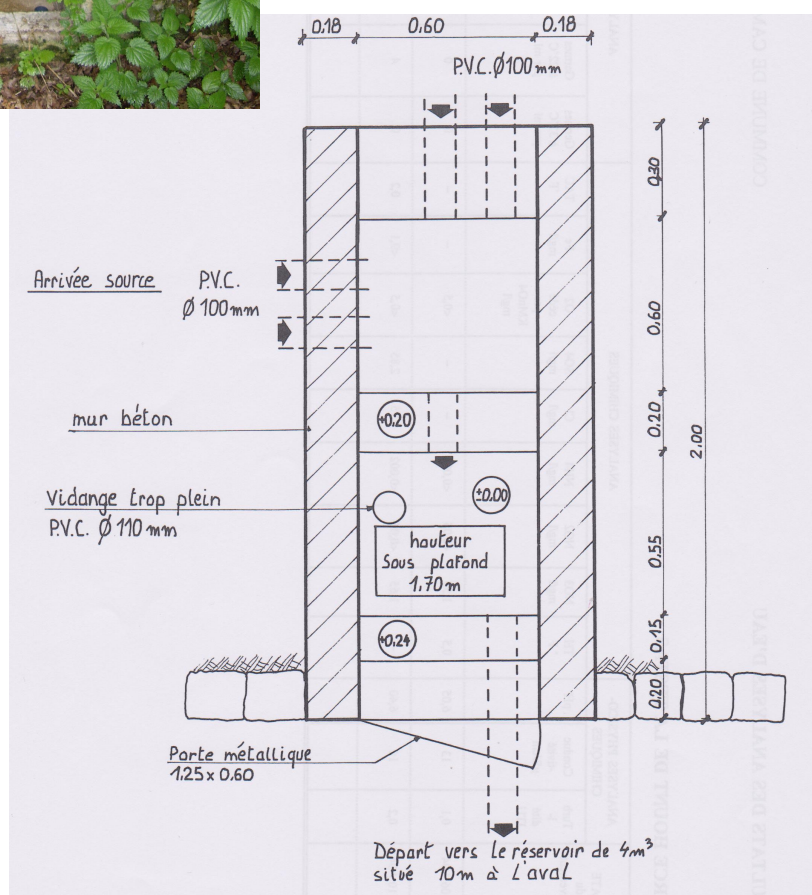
PLAN ET PHOTO DU CAPTAGE DE LA HOUNT DE LAS TESTAS
